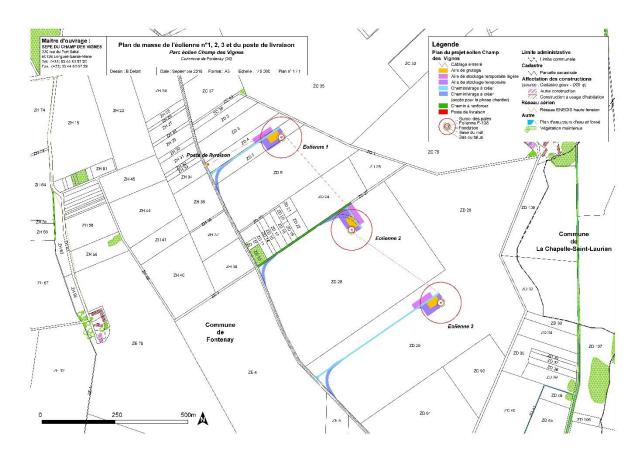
Plan de masse du parc éolien du Champ des Vignes
